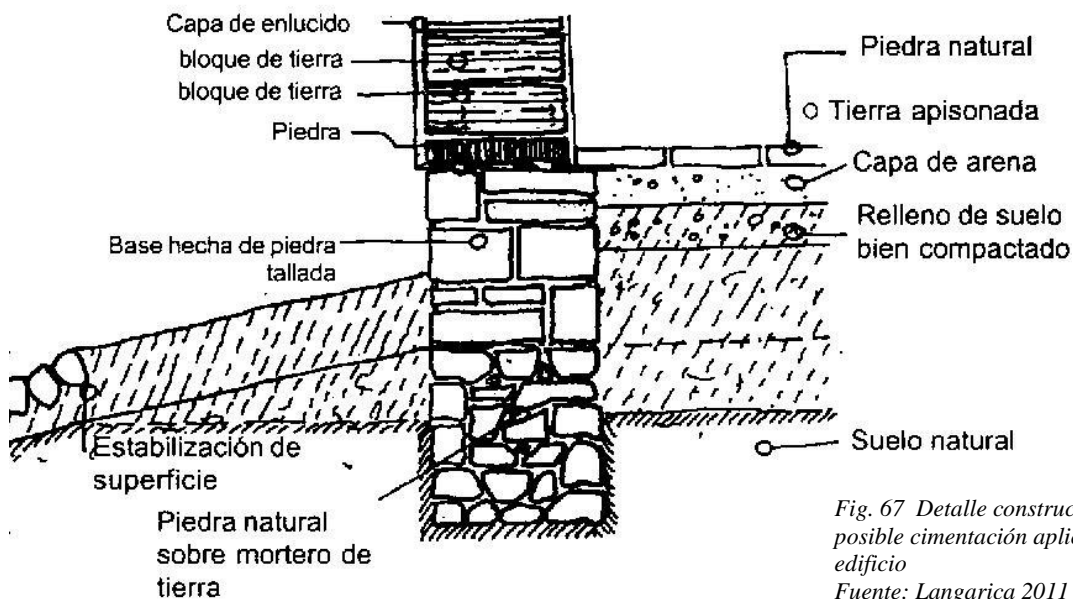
Detalle constructivo de la posible cimentación aplicada al edificio
